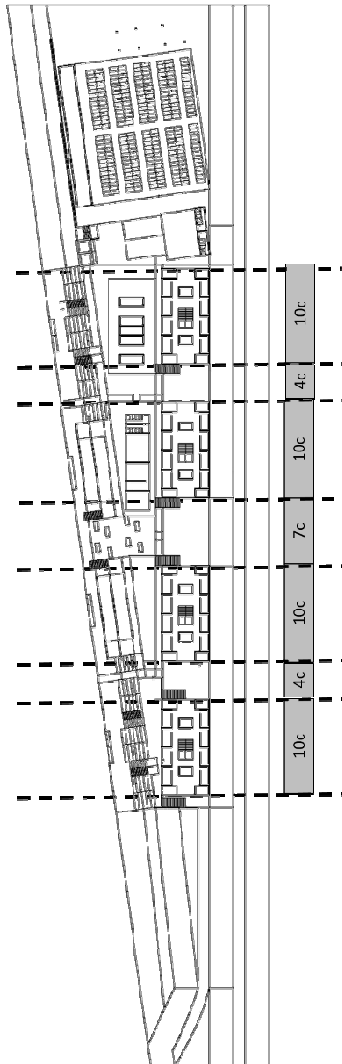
Salah satu denah bangunan pada rancangan yang terbentuk dari susunan peti kemas
